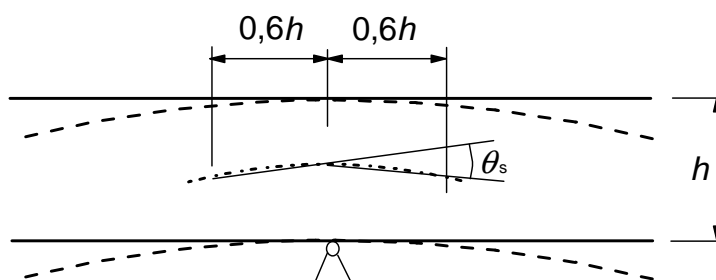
Rotação plástica  $\theta_s$  de secções de betão armado para vigas contínuas e para lajes contínuas armadas numa direcção
